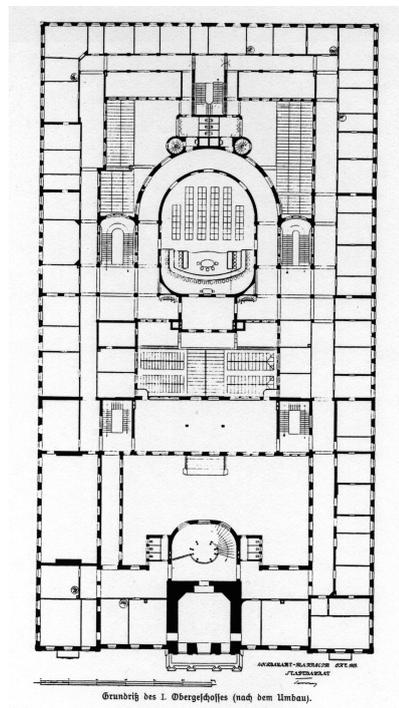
Grundriß des 1. Obergeschosses nach dem Umbau
